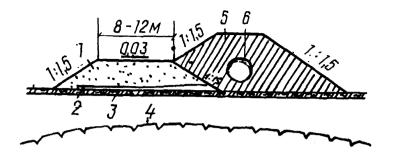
Поперечный профиль насыпи с хворостиной выстилкой на участках четвертой группы ландшастных комплексов при наземной прокладке трубопровода:
